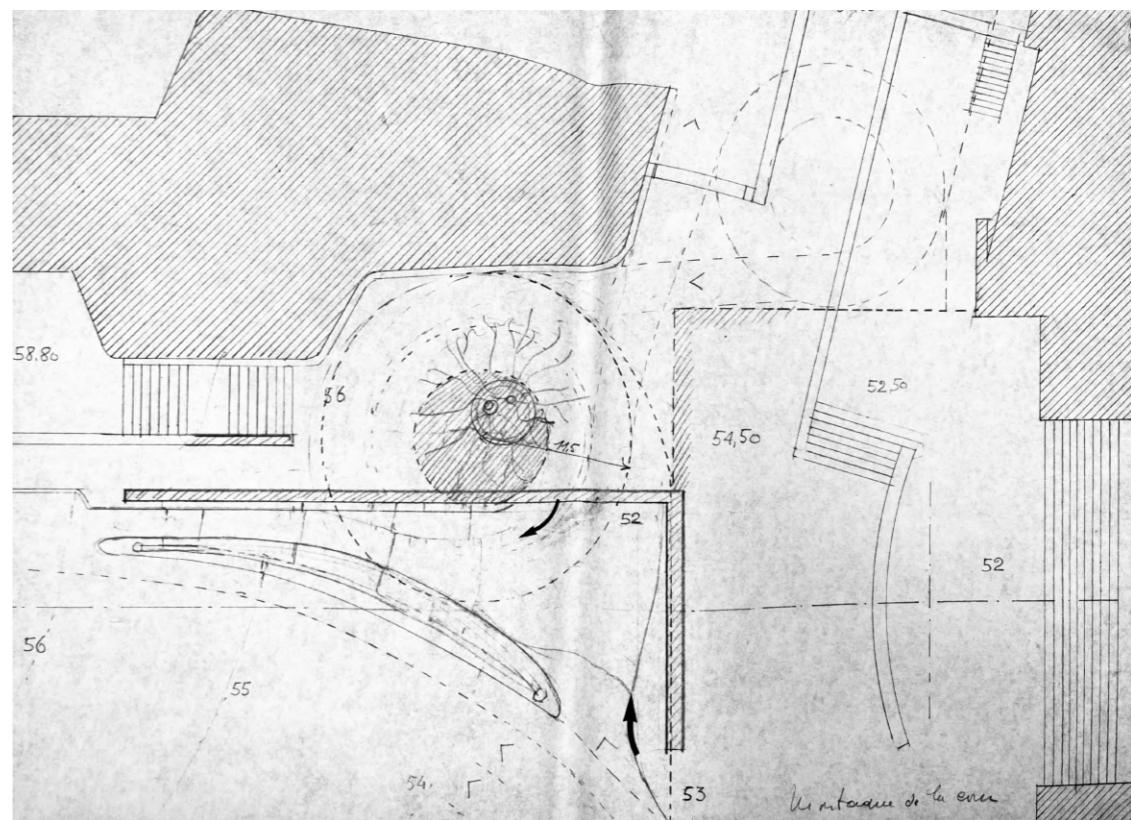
Plan de la rampe de parking débouchant sur la rue Montagne de la Cour.
